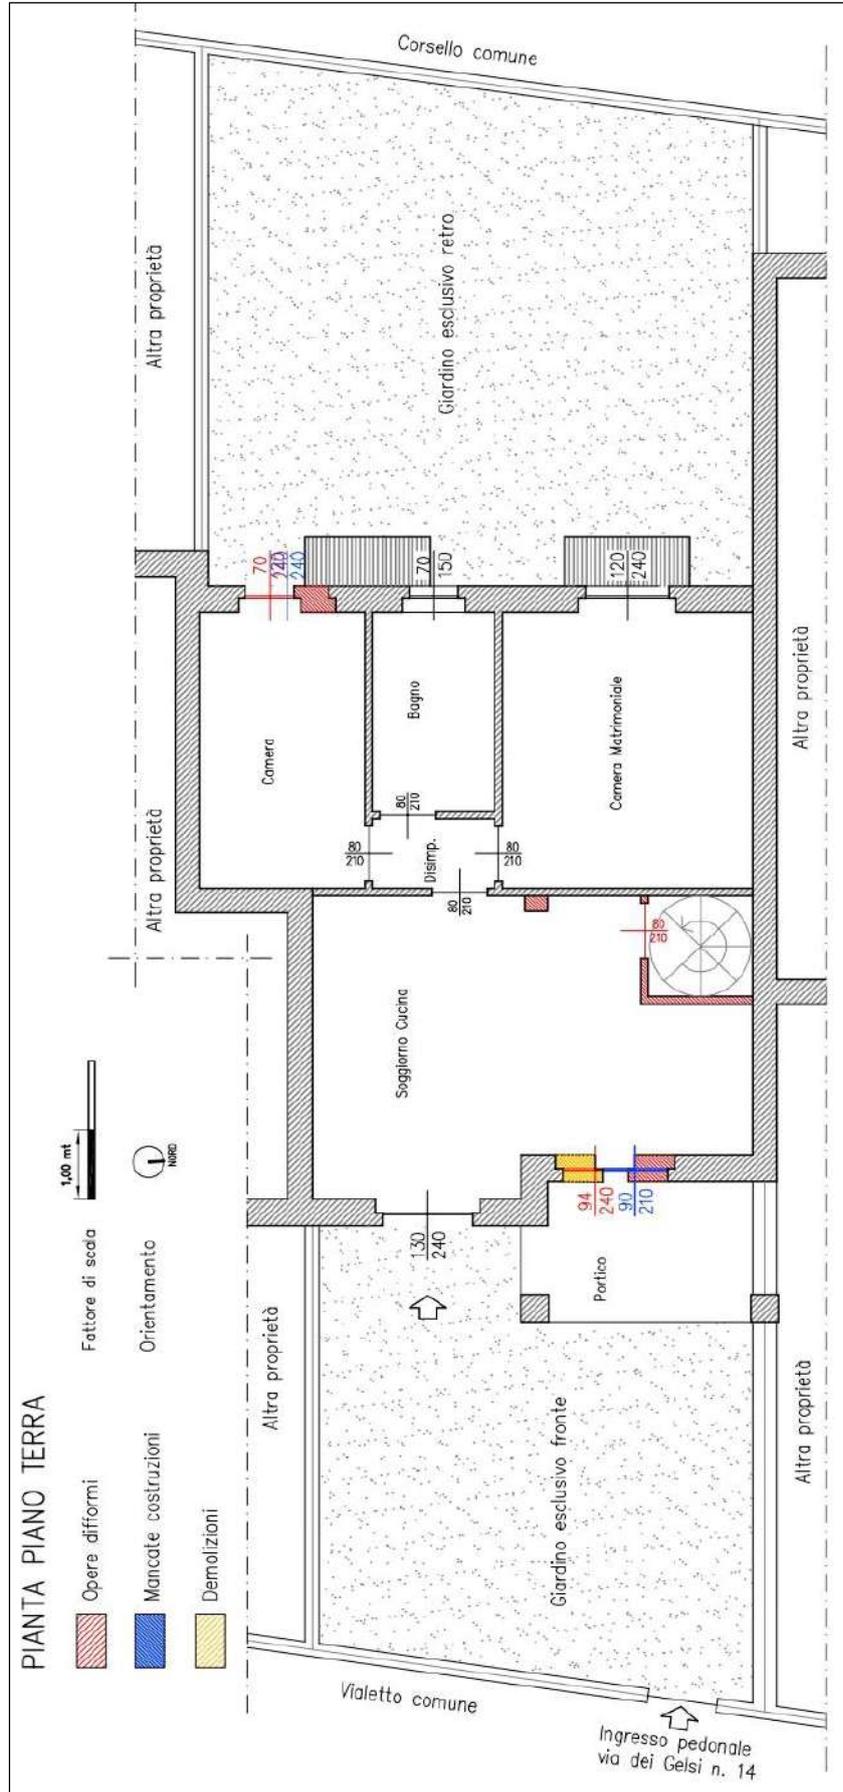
Pianta piano terra - confronto con D.I.A. n. 05 Prot. 1315 del 09.02.2005
